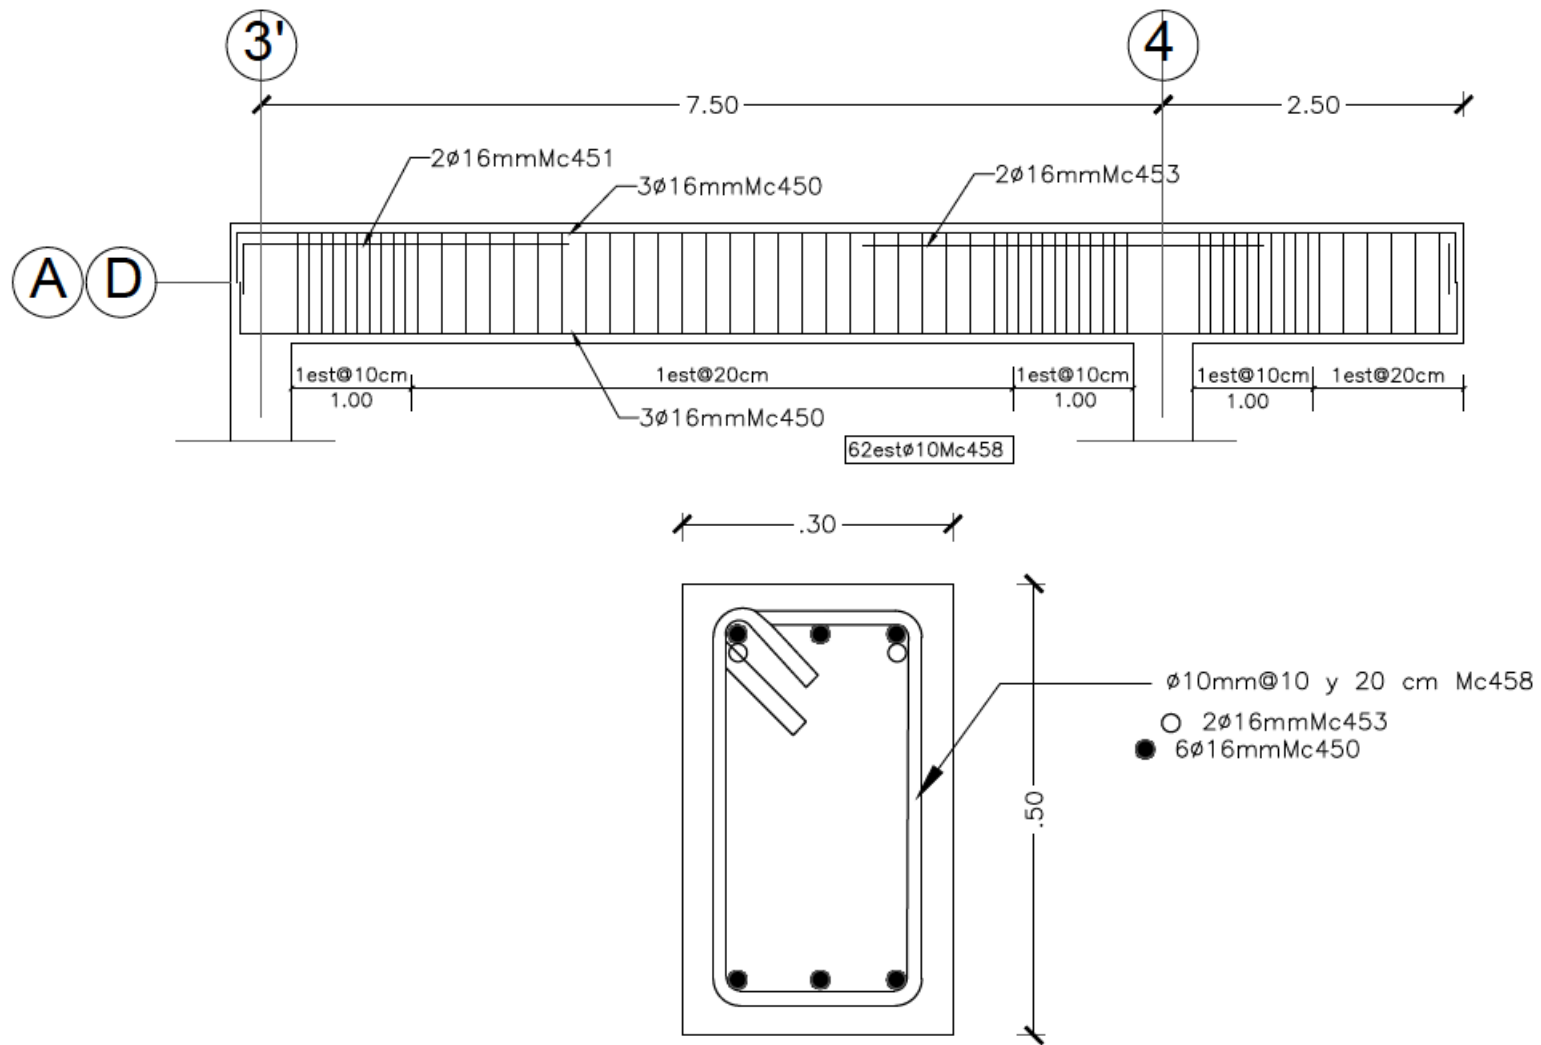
Detalle viga 30 cm x 50 cm, armado de 8 ϕ 16
